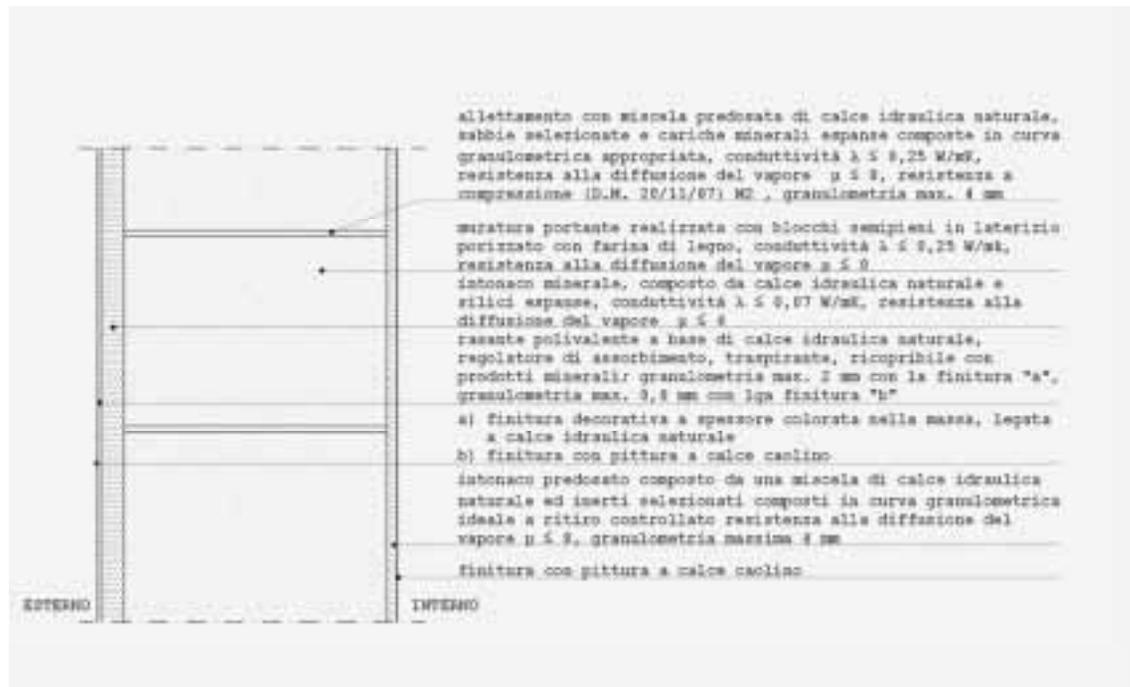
Pacchetto murario proposto nel progetto esecutivo.
